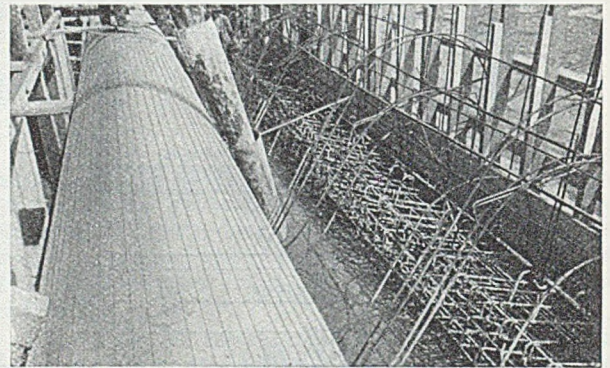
Spannbetonrohr mit Gelenkbewehrung.
